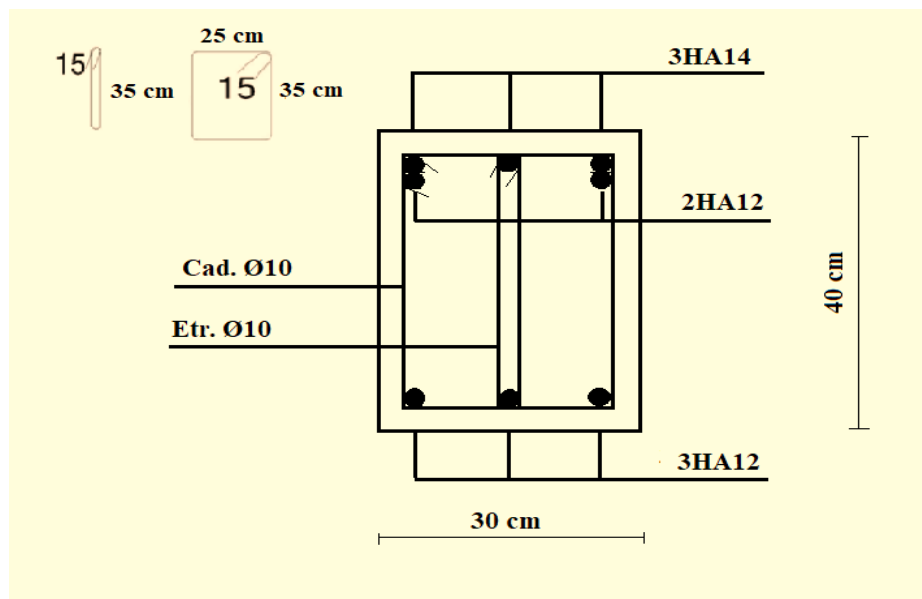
Ferrailage des poutres secondaire au niveau d'appuis pour 8^{ème} étage
